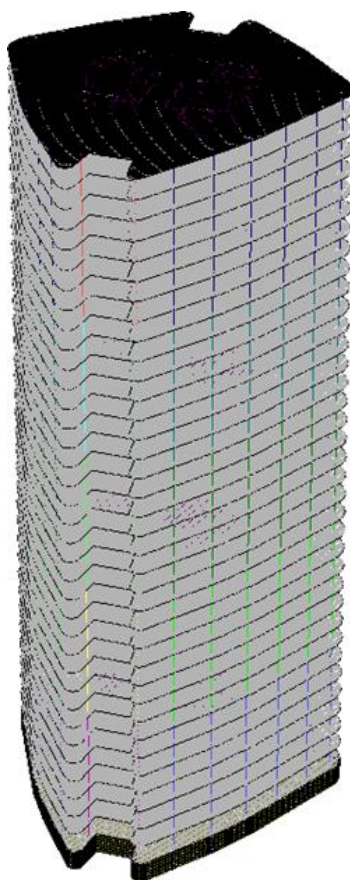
Розрахункова схема будівлі в ПК SCAD
